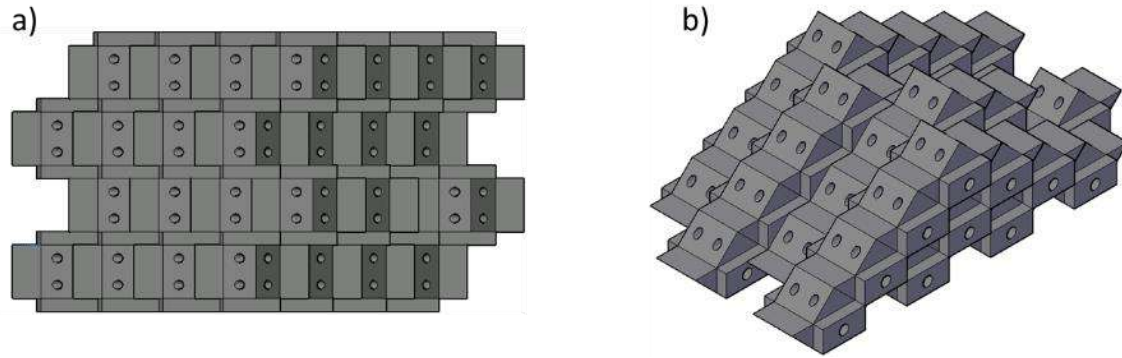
Dique modular sumergido (sección transversal, a) vista en planta, b) vista isométrica).
